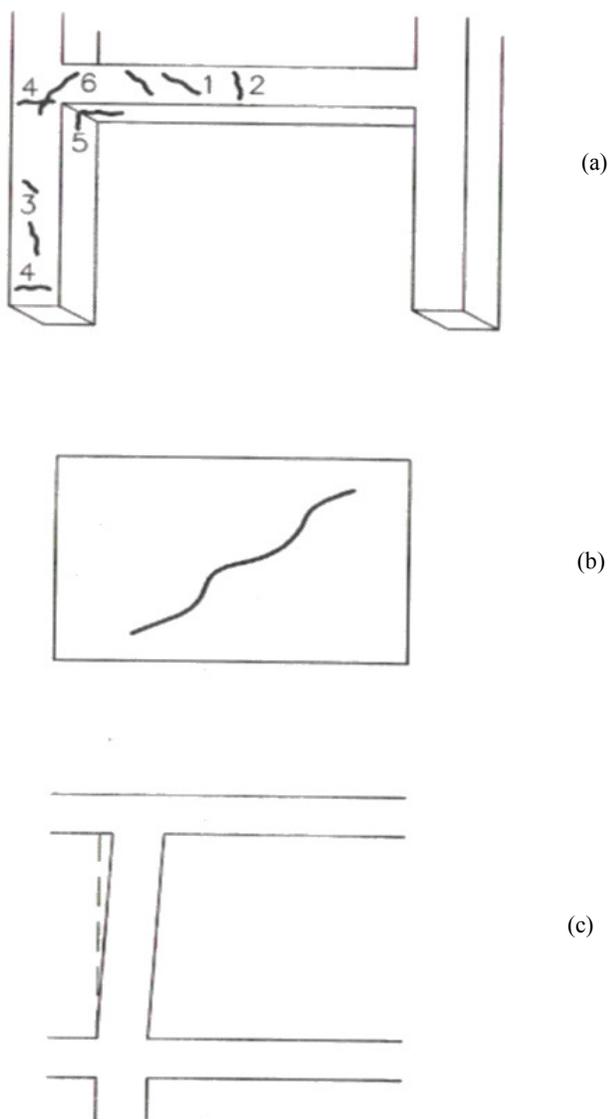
Tipos de grietas en el sistema resistente vertical de mampostería no reforzada.
